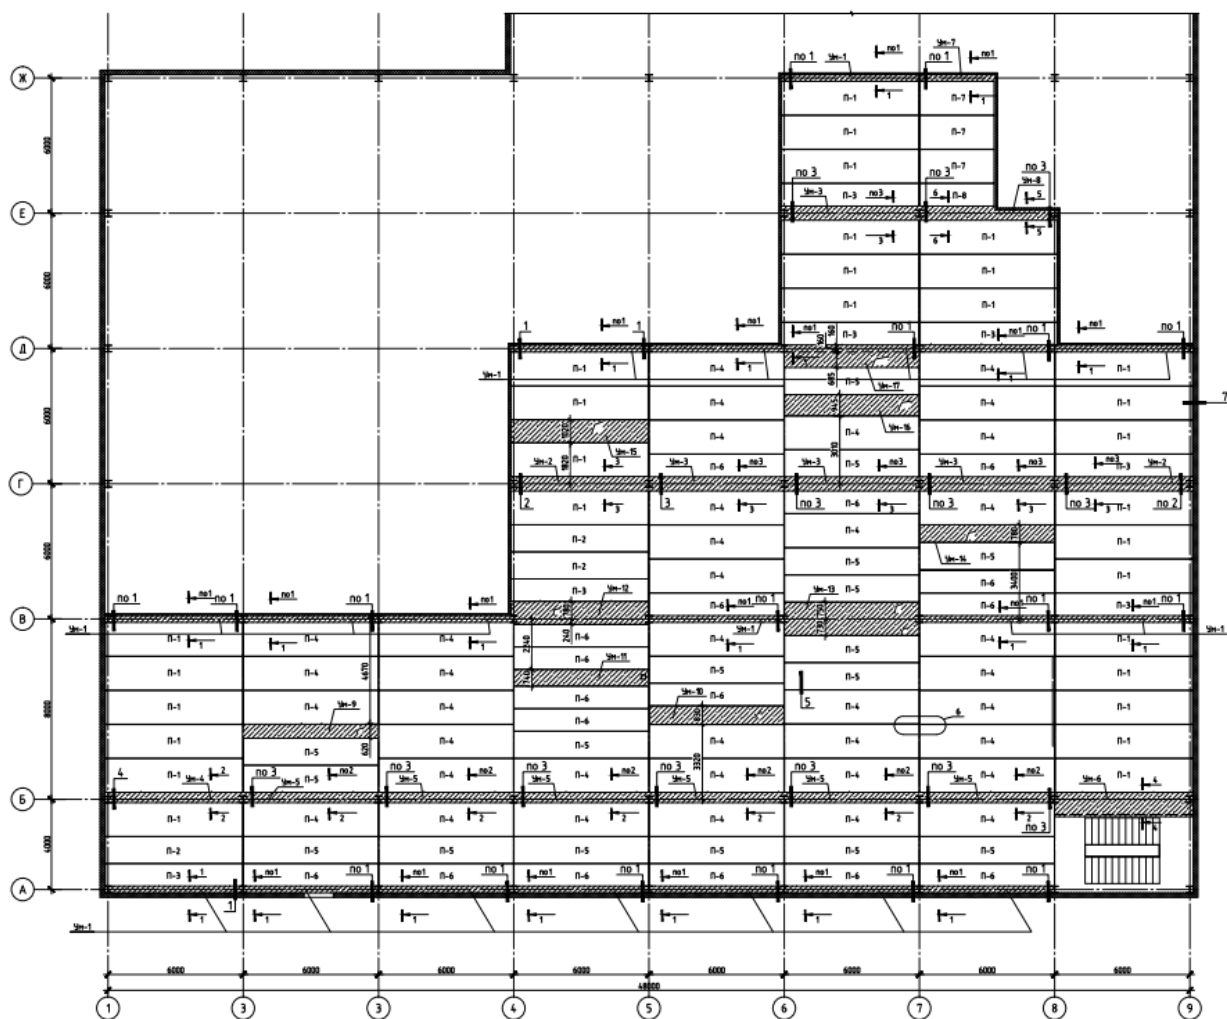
Схема расположения плит перекрытия на отм. +3.300
